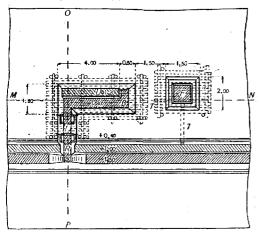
Легное вентиляционное убежище с фильтром из растительной земли: R—вход; L—тамбур; U—убежище; B—вентиллятор; T—трубы, проводящие воздух; F—фильтр.
